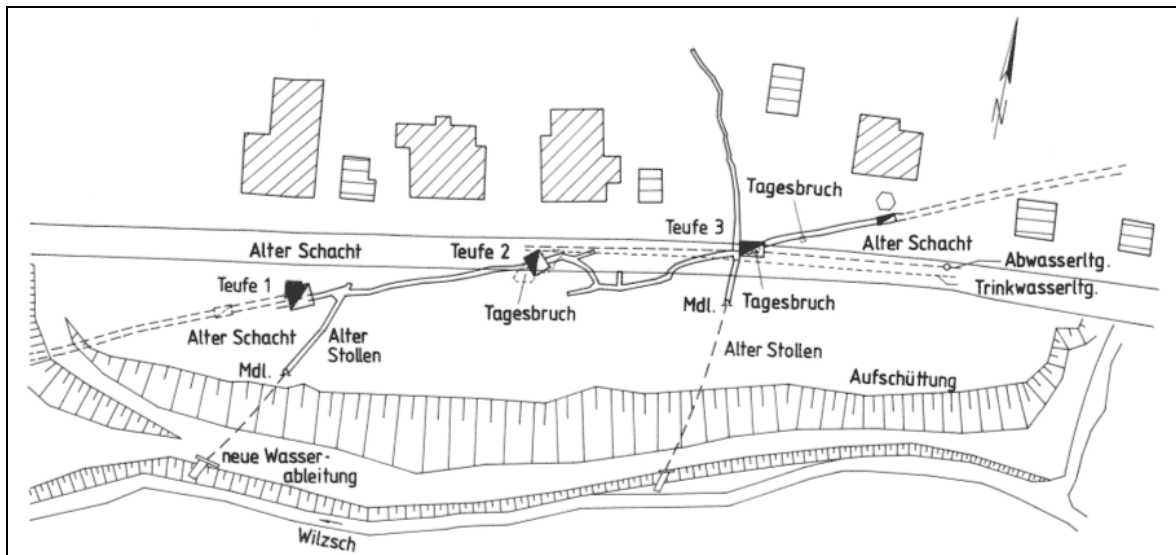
Lageplan mit tagesnaher Altbergbausituation im Straßenbereich
